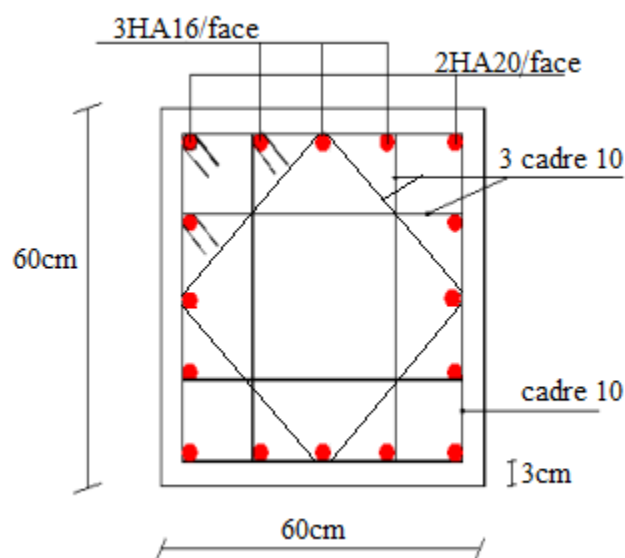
Schéma de ferrailage poteau s-sol + RDC+1^{ère} étage
